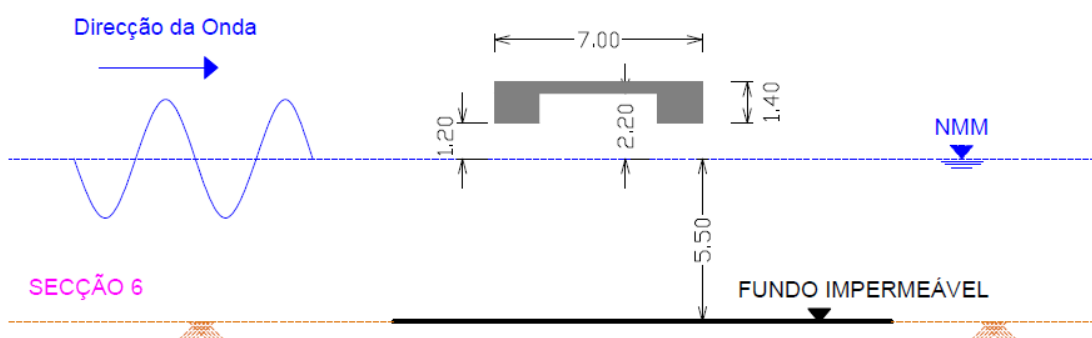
Secção transversal 6 da Ponte-Cais e respectivas dimensões em metros.
